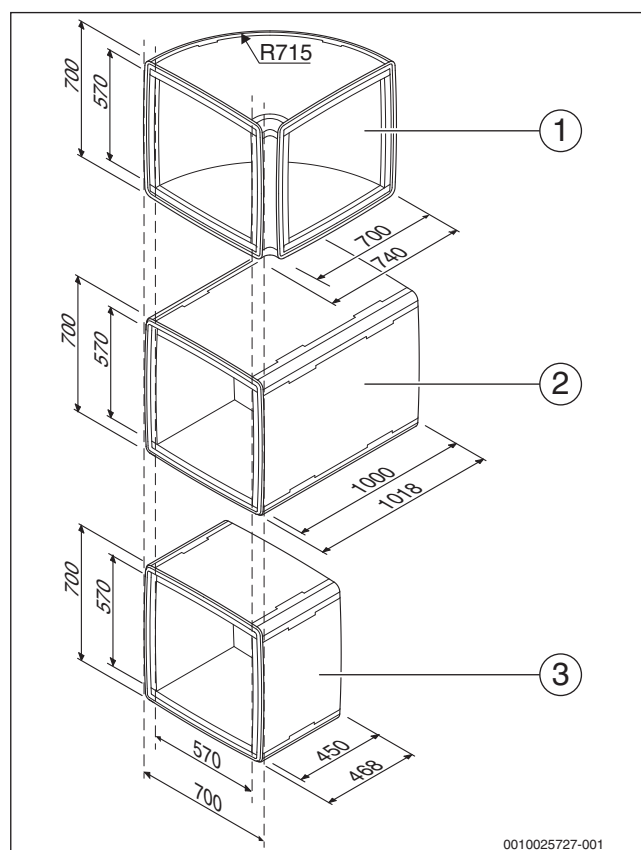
Beispiele für Luftkanäle Querschnitt 700 (alle Maße in mm)
